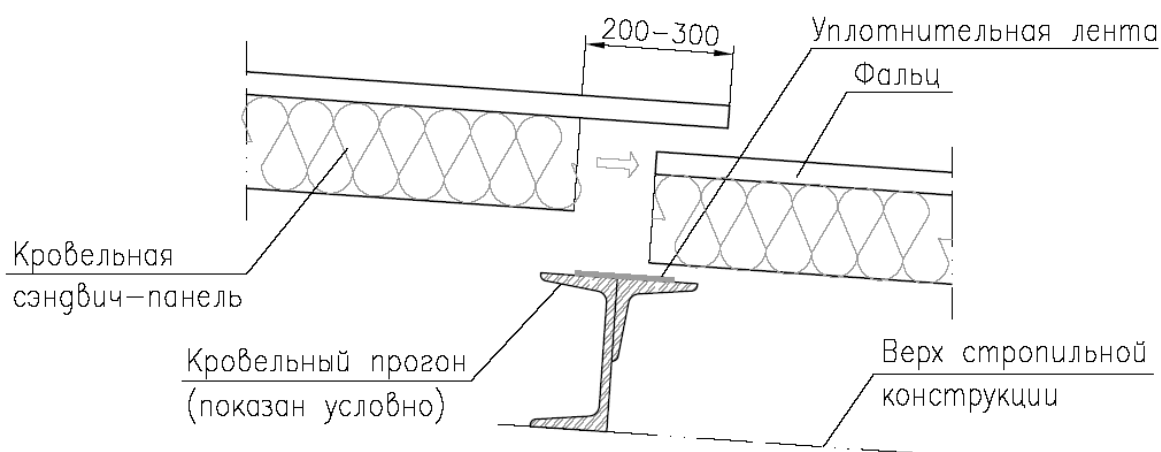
Нахлест кровельных панелей. Начало монтажа
